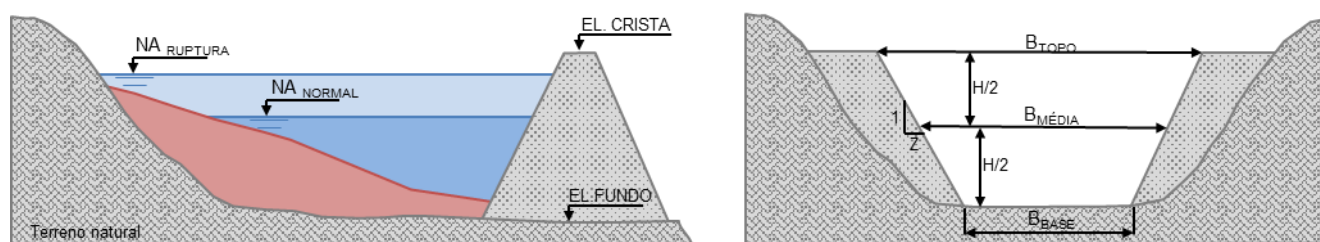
Croqui com as dimensões da brecha de ruptura.
